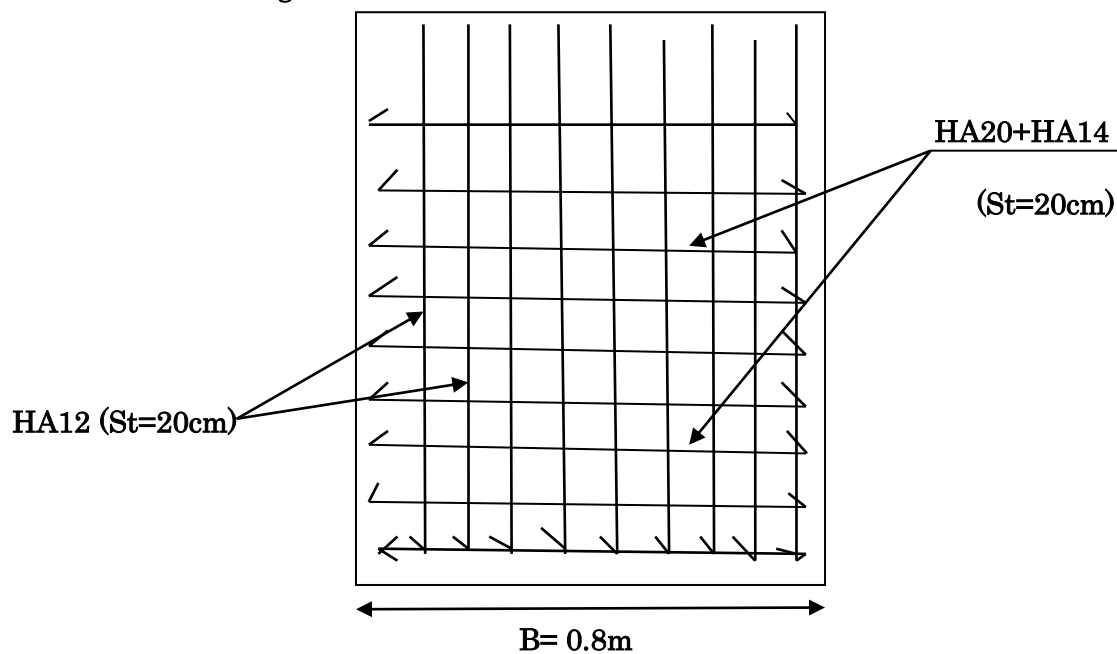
Schéma de ferrailage de la semelle du mur
